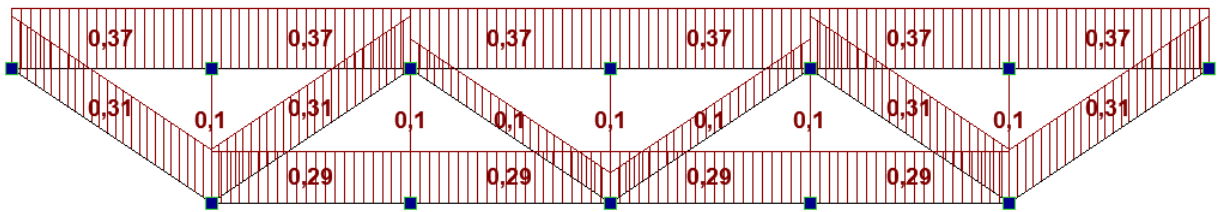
Загрузка собственным весом фермы, кН/м
